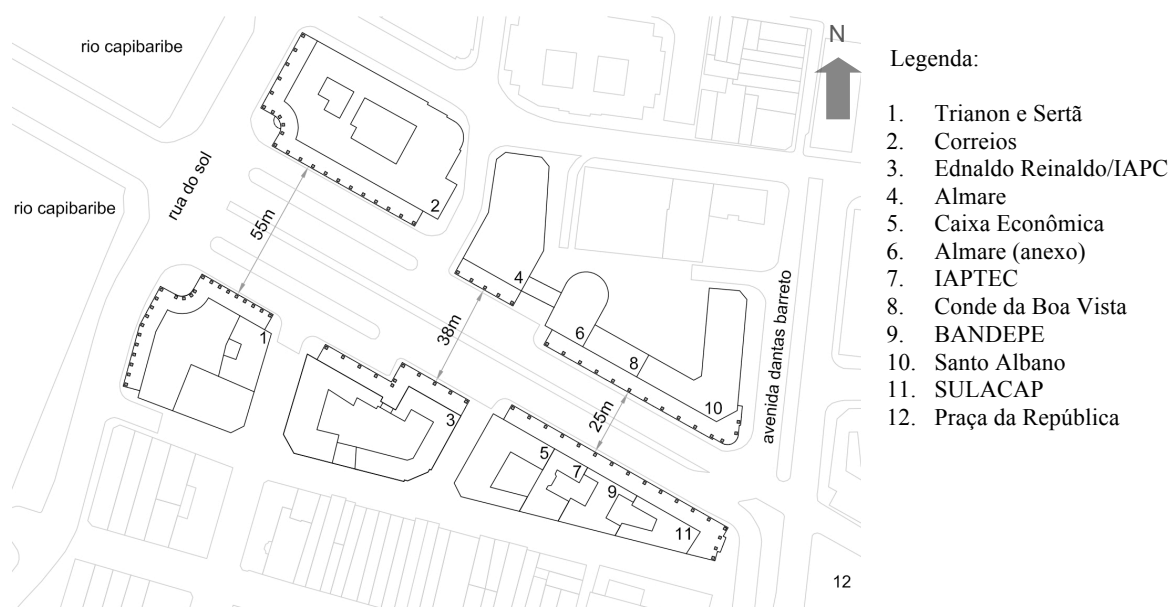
Planta baixa com legenda da Avenida Guararapes, Recife, Brasil.
